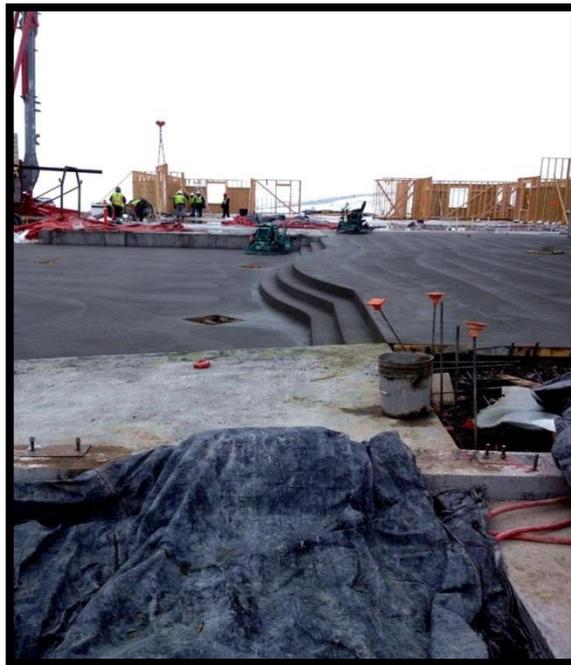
Slab Concrete. Autor: Providence Hall High School.
